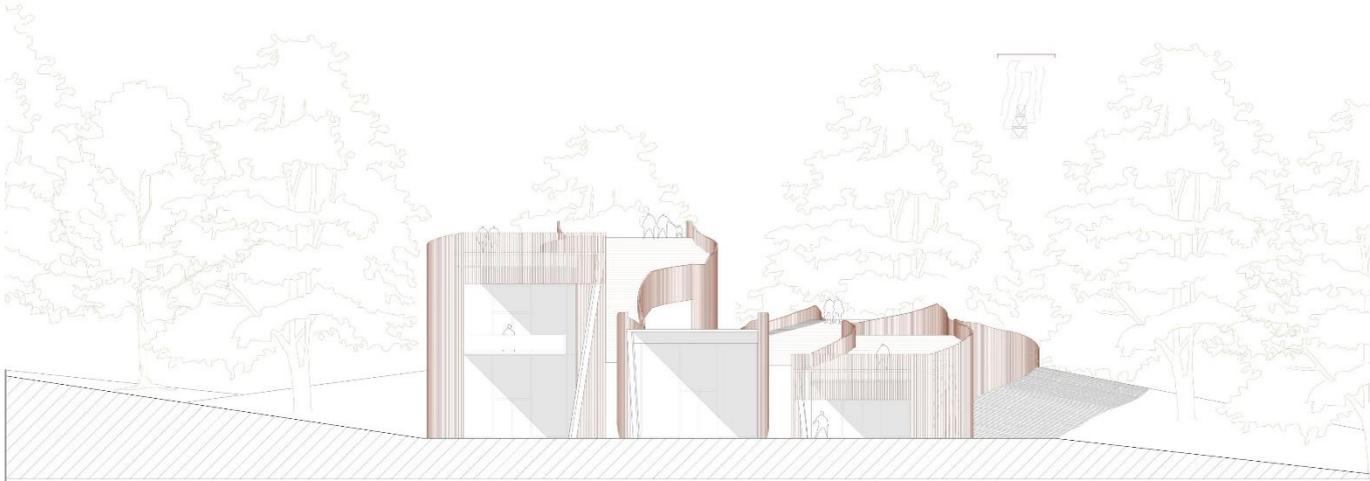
Alzado sureste. Escala 1:400 Elaboración propia.
